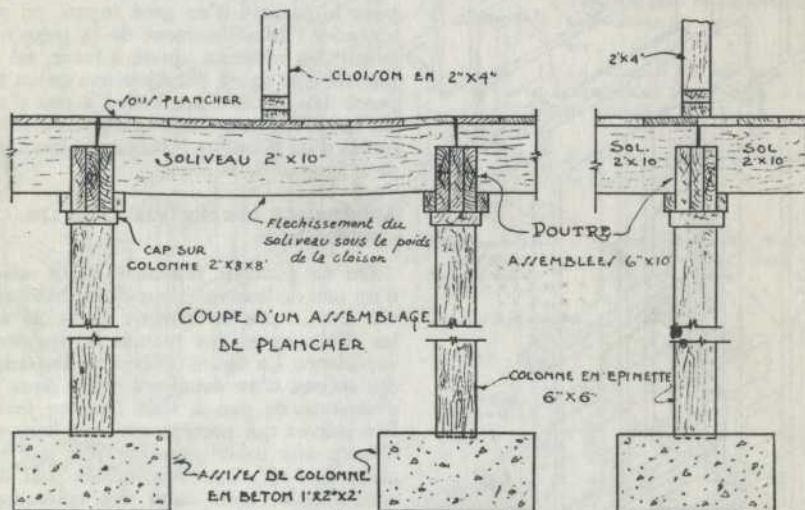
Fausse disposition de poutres sous une division ma tresse causant le fléchissement du plancher.
